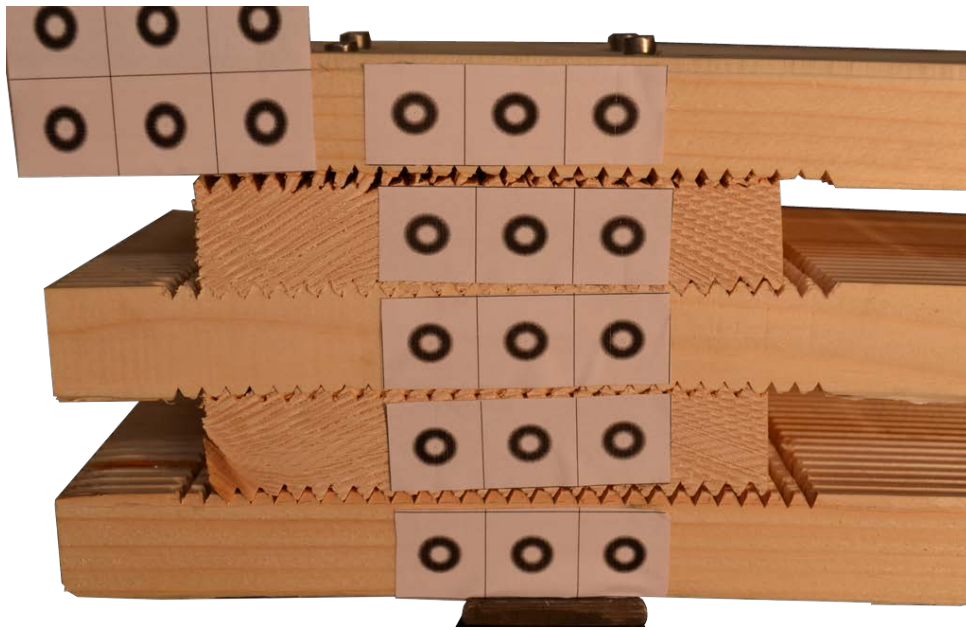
Poutre 3 : Rupture de la denture d'assemblage au niveau de l'appui
